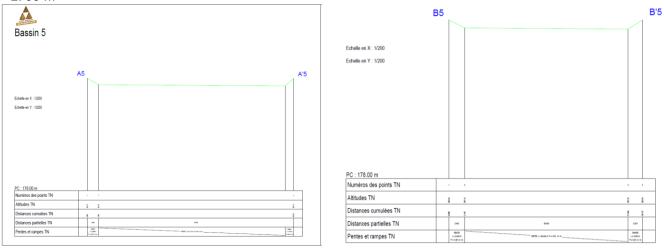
Coupe AA' et BB' du bassin pluvial n°5 de la zone existante Nord Bassin 6
